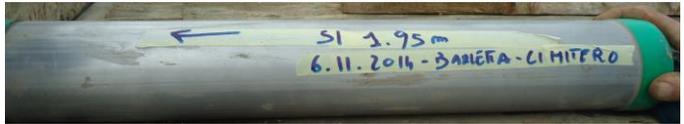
Campione indisturbato S1 prelevato nell'intervallo 1,95 – 2,45 m - Certificati in allegato dal N. 5631 al N. 5636
